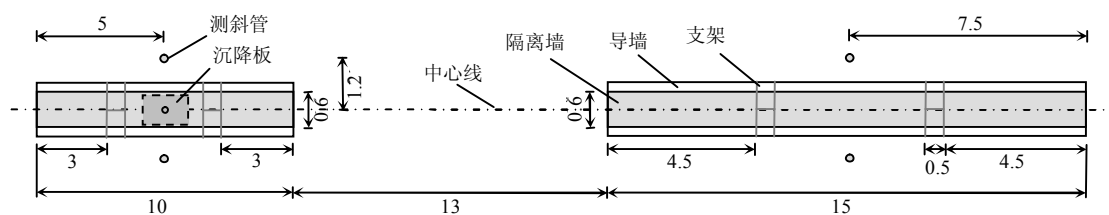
隔离墙及监测系统布置平面示意图 (单位: m)
